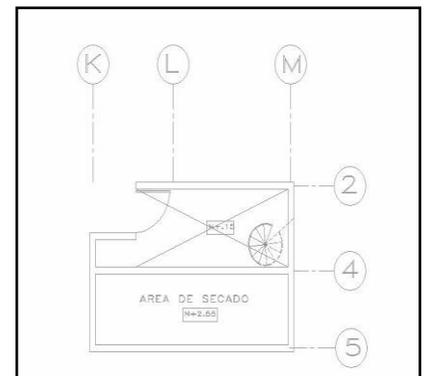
(Fuente: SISCA,SA) Propuesta Inicial con Mezanine en area de lava y plancha
